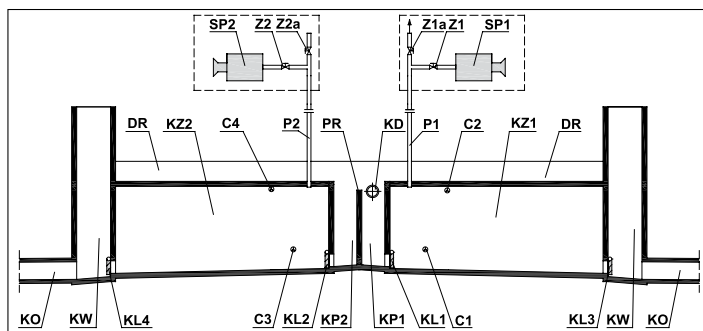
Przykładowe rozwiązanie zbiornika retencyjno – przerzutowego: przekrój B – B
